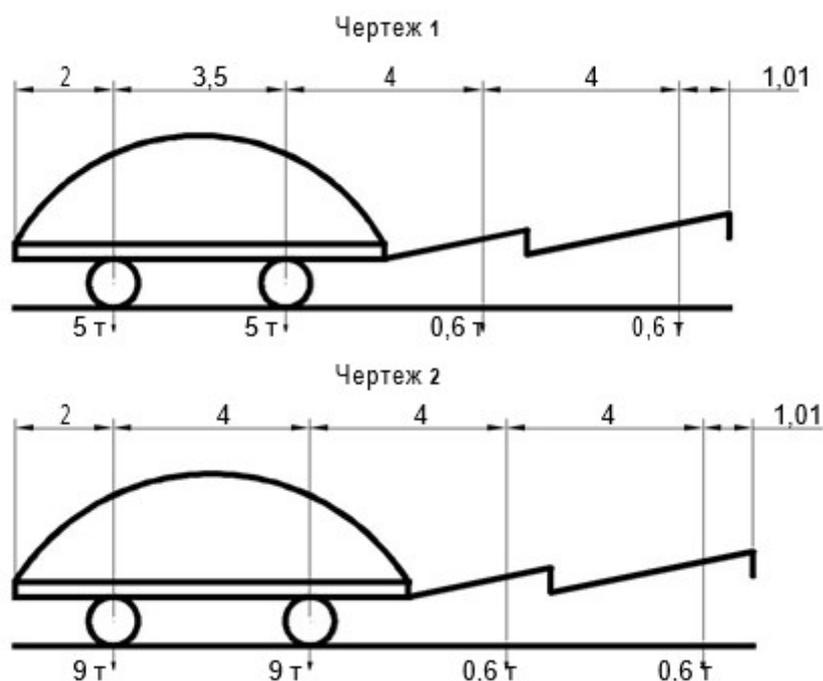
Схема установки дорожной нагрузки 1891г
